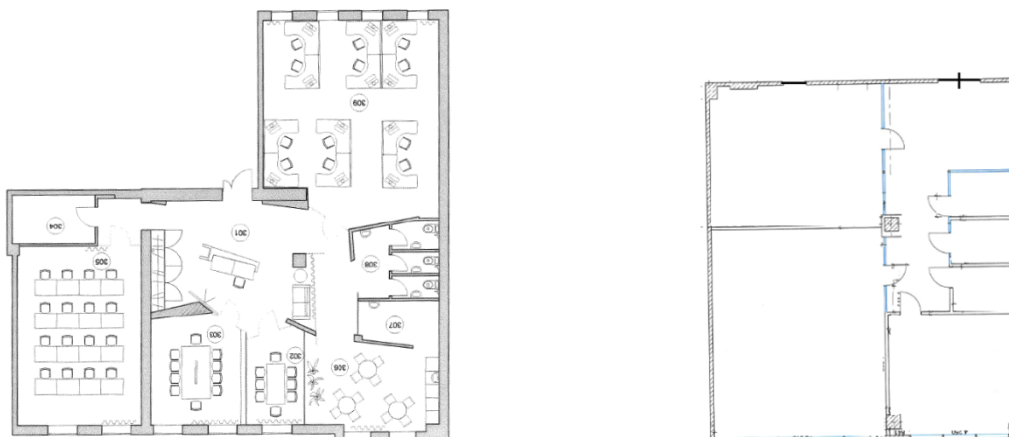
Київ.Україна. БЦ "Леонардо" Фрагмент плану 3 поверху, 12 поверху
